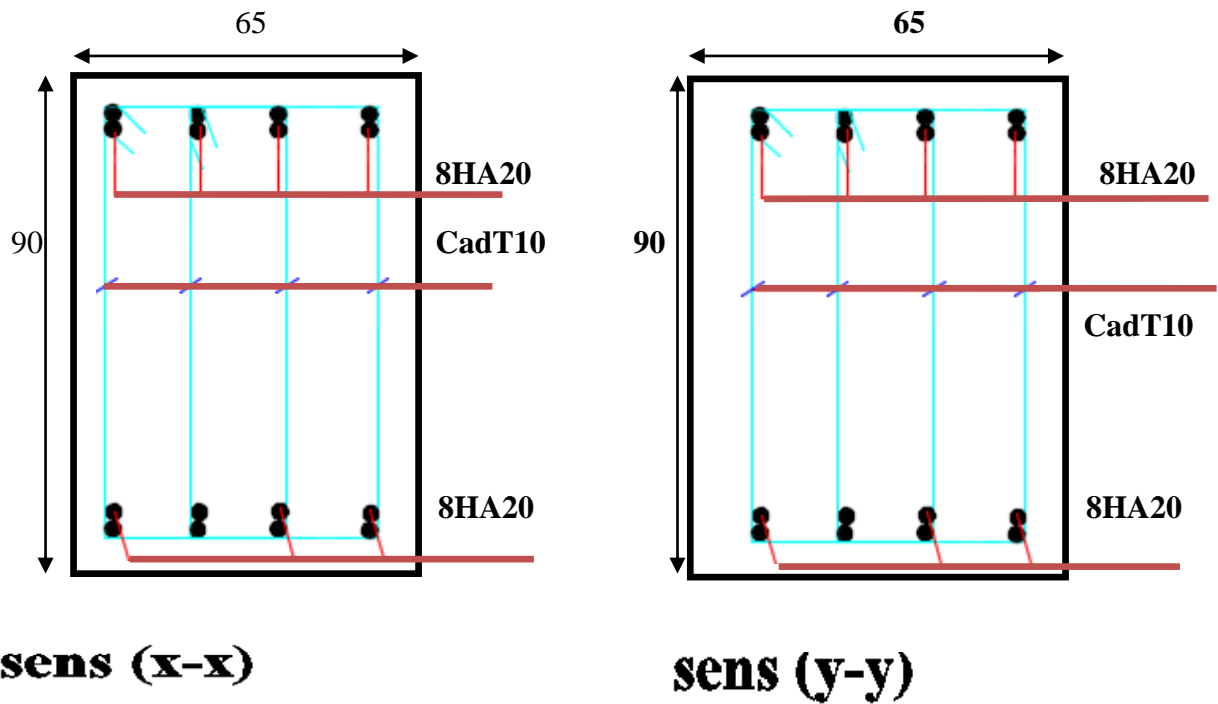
schéma du ferrailage de la nervure sens X-Y
